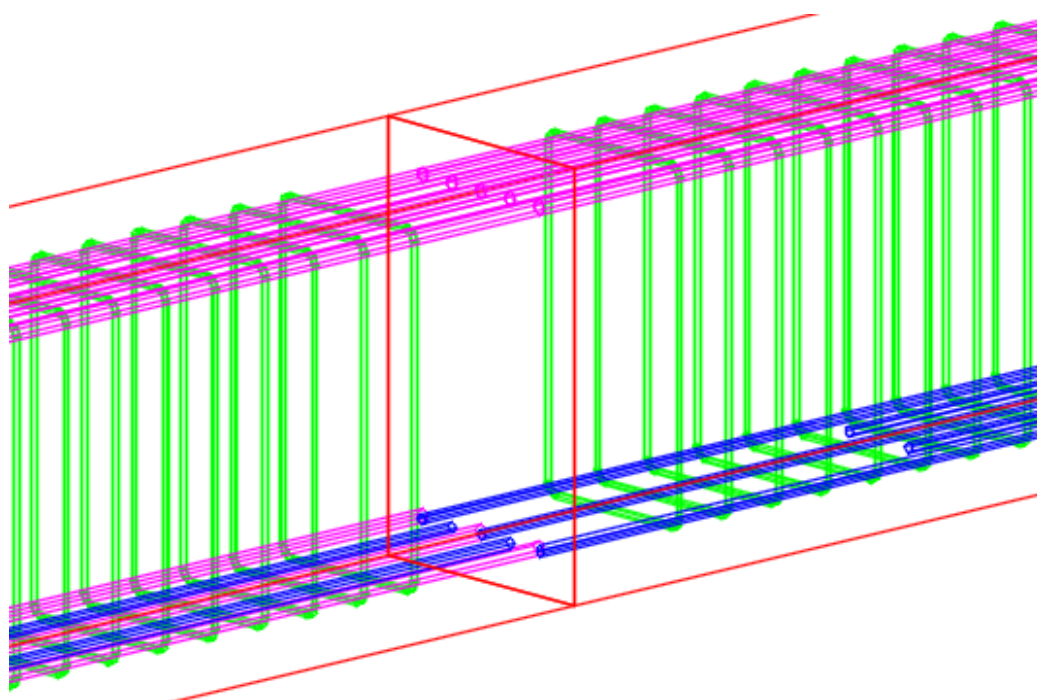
Pormenor viga completa barras (5, 6 e 7) – ligação entre tramos.
